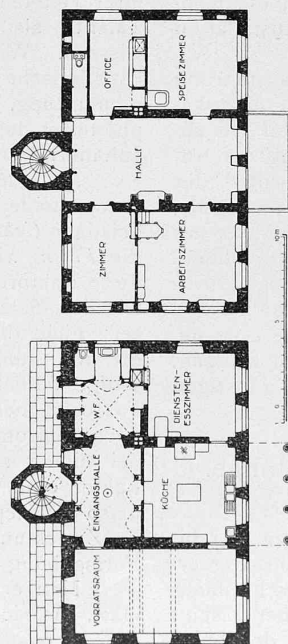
und 4 (in der Mitte) Grundrisse 1 : 400.
